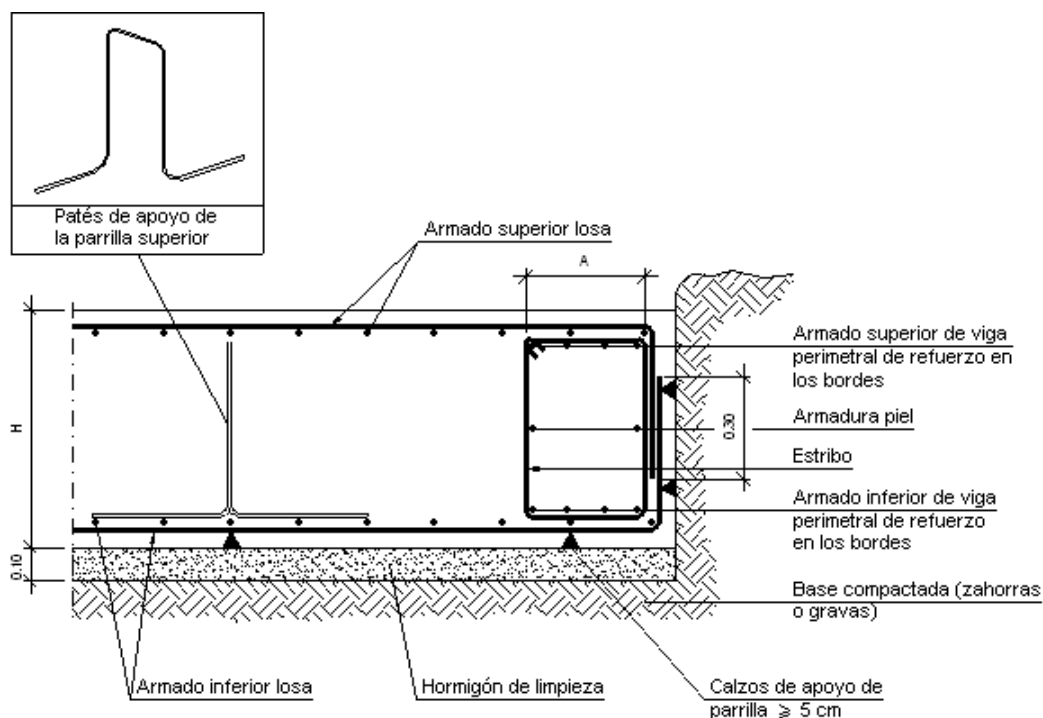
Detalle losa de cimentación Fuente: www.detallesconstructivos.cype.es
